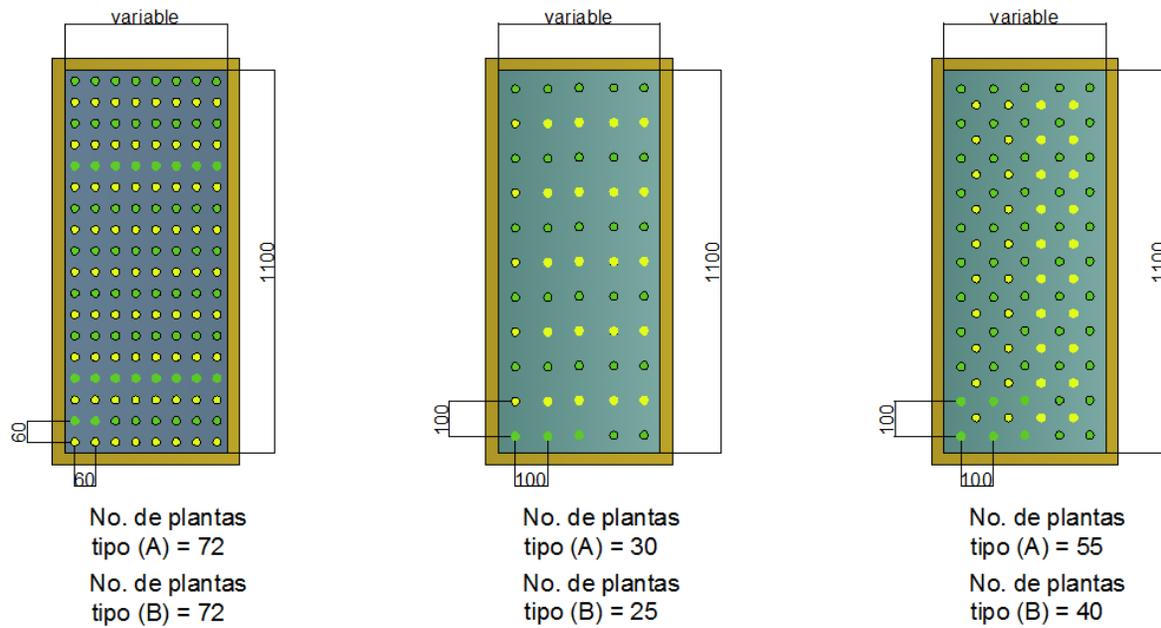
Distribución de plantas usando dos especies en filas alternadas
